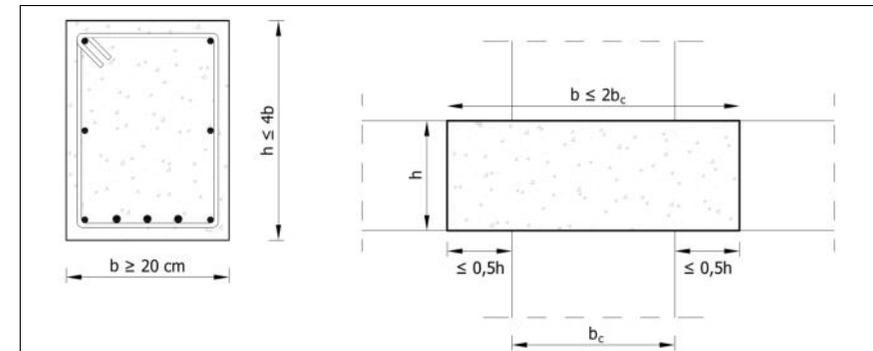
Limitazioni geometriche per la sezione di una trave (NTC08 § 7.4.6.1.1)
